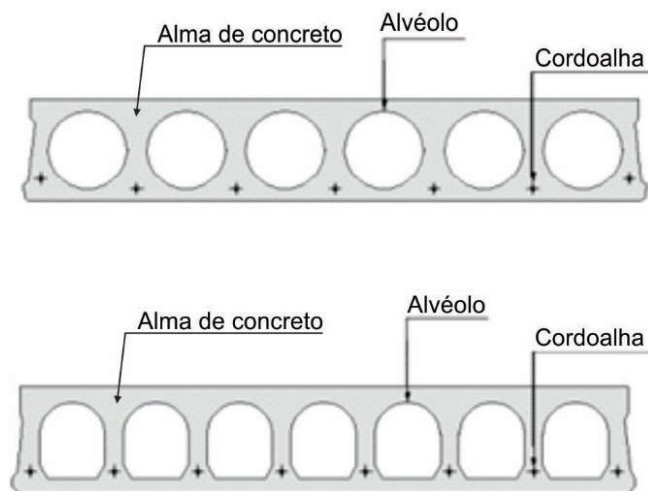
Seção transversal de laje alveolar e geometria dos alvéolos.
